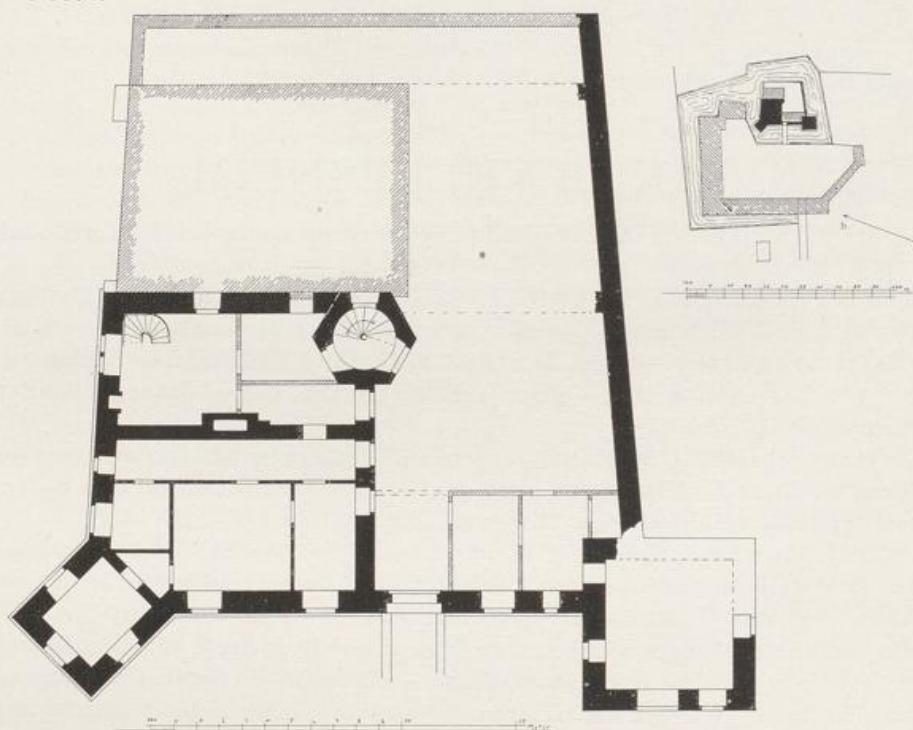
Bubenheim. Lageplan und Grundriss des Herrenhauses.
